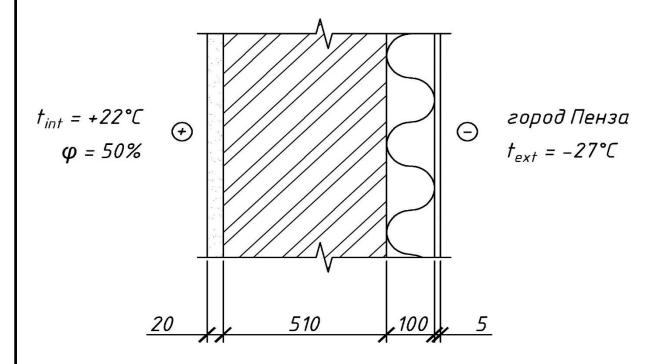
Конструкция утепления стены снаружи с использованием в качестве утеплителя плит из пенополистирола.
